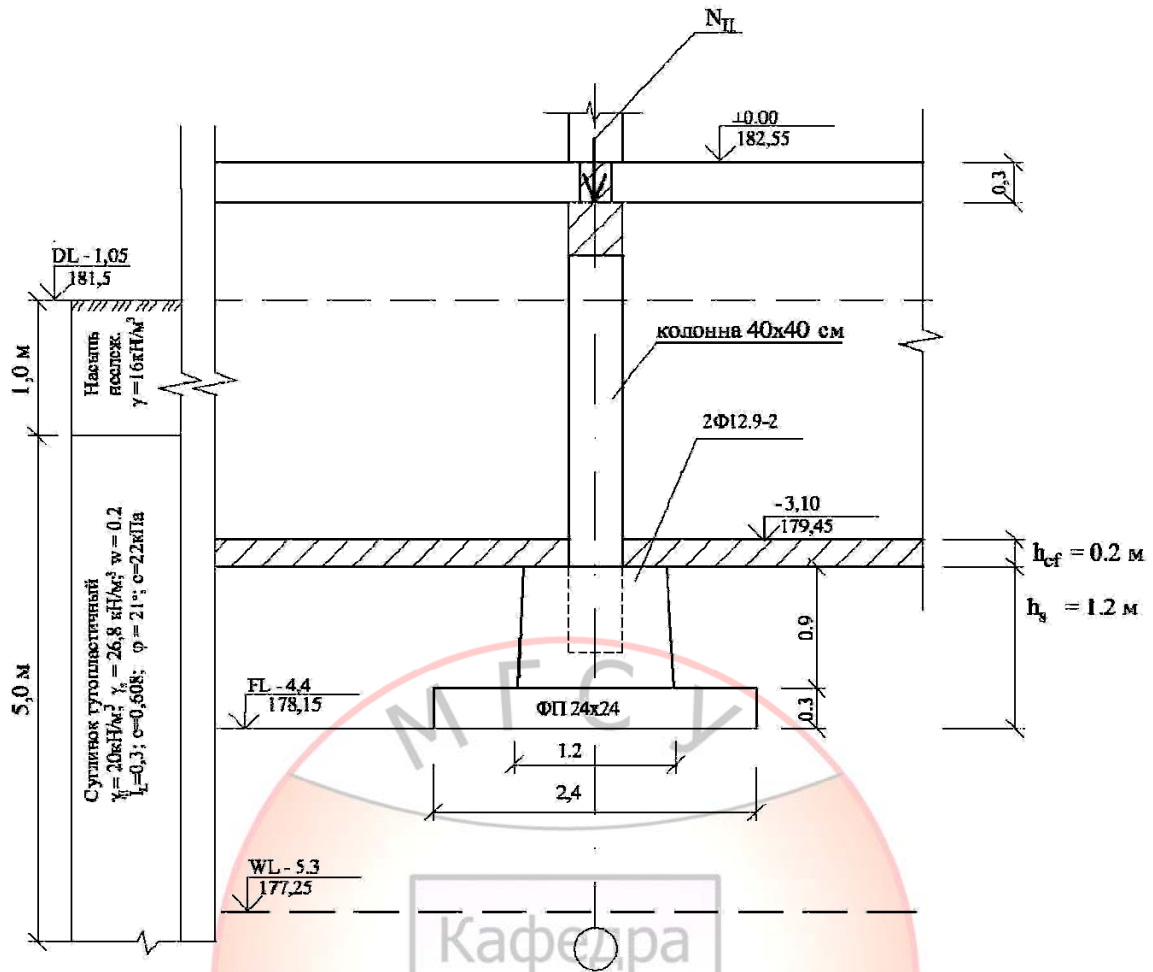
Схематичный разрез фундамента под внутреннюю колонну здания каркасного типа.
